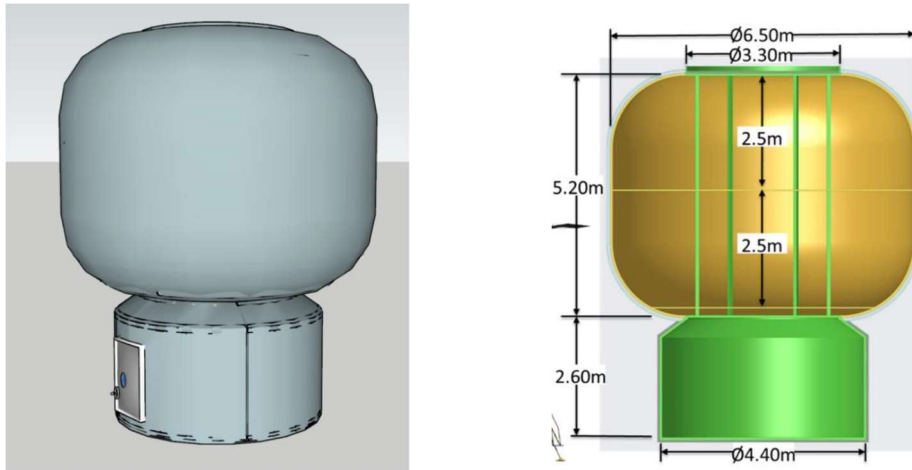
, 34_ Disegno di riferimento del SH; Dimensioni del SH.
